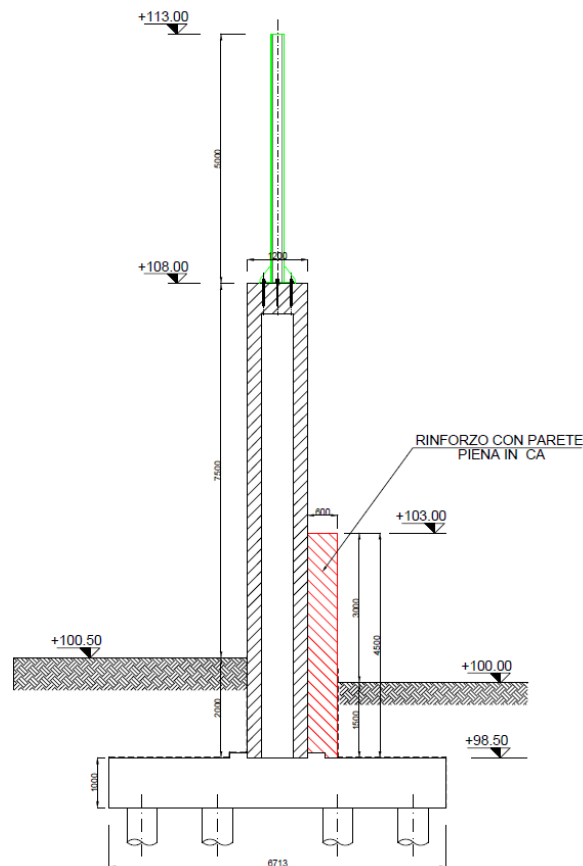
Schema della barriera acustica da collocare sull'esistente muro interno di protezione.
